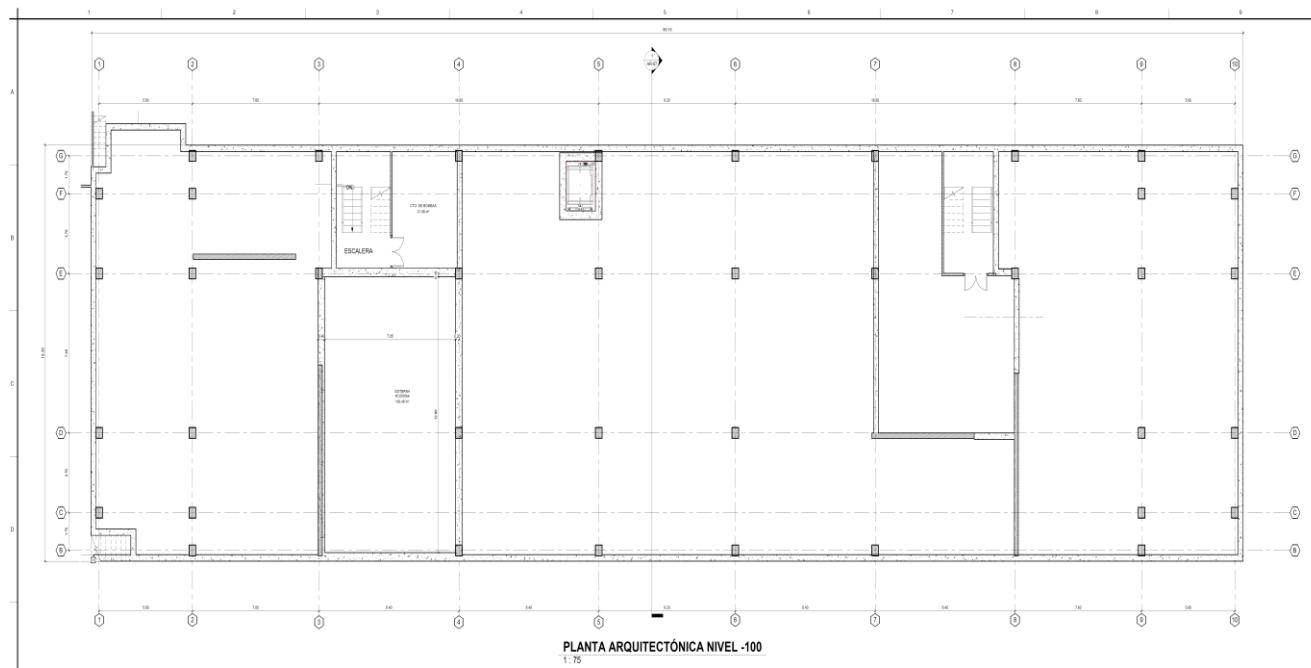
Vista de la Planta Arquitectónica Nivel 100.
